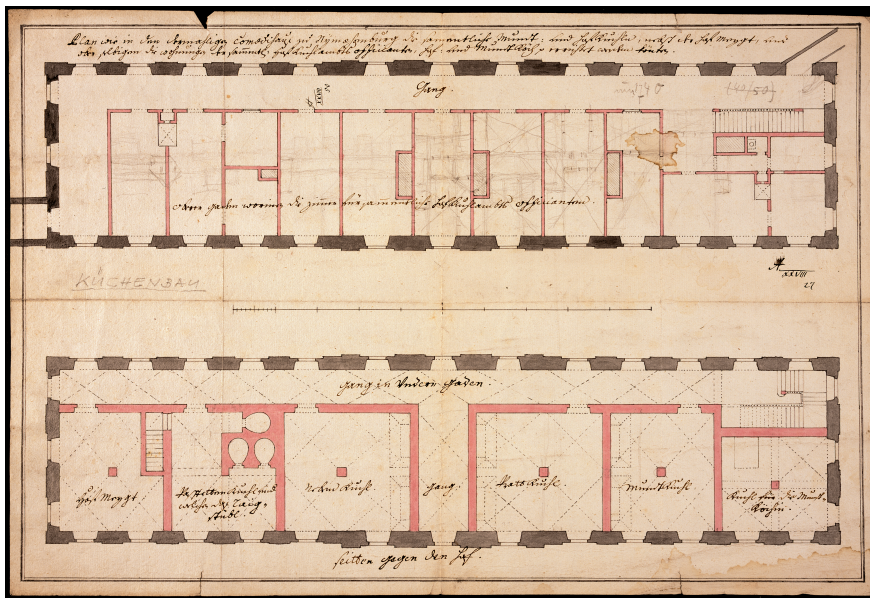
Grundriss der ersten Orangerie mit einem ersten Vorschlag zum Umbau zum Küchenbau (Unbekannt; BSV, Bauabteilung).
